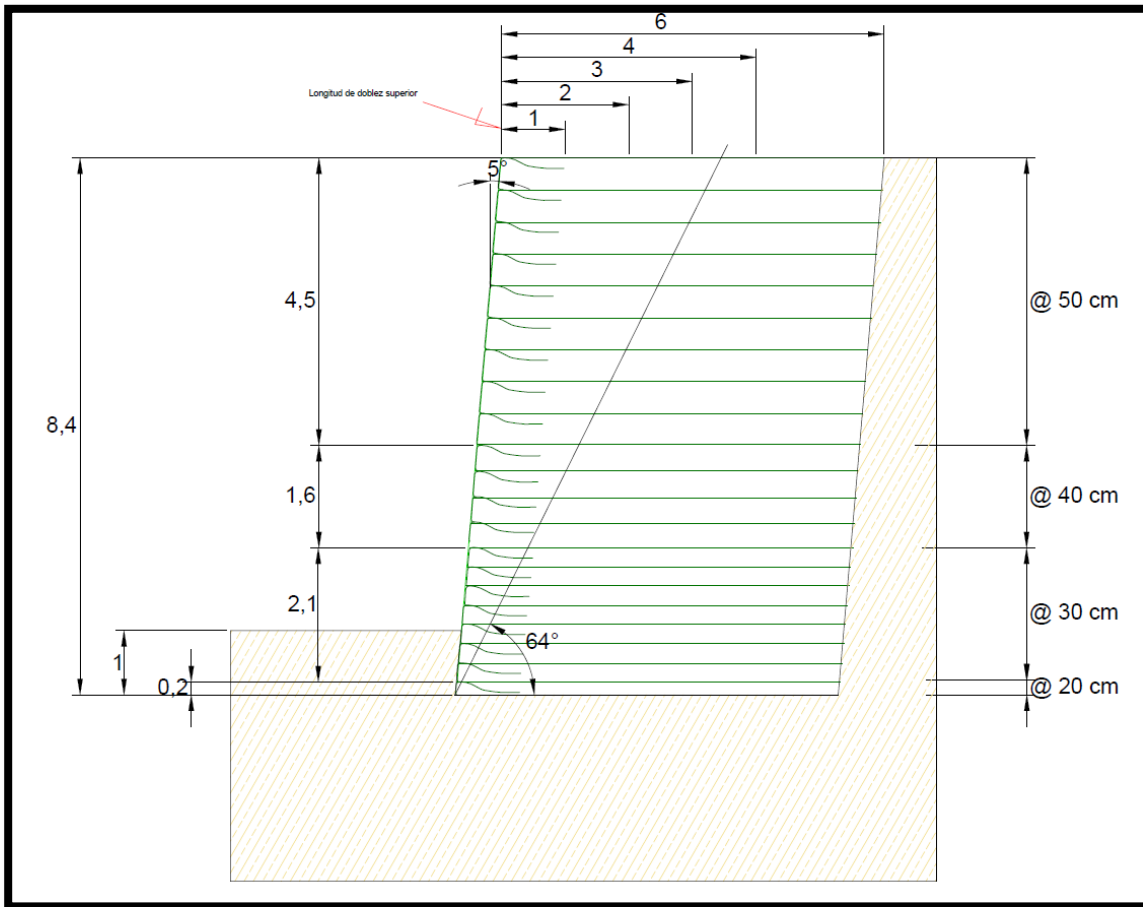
Dimensiones de muro reforzado con geotextiles
